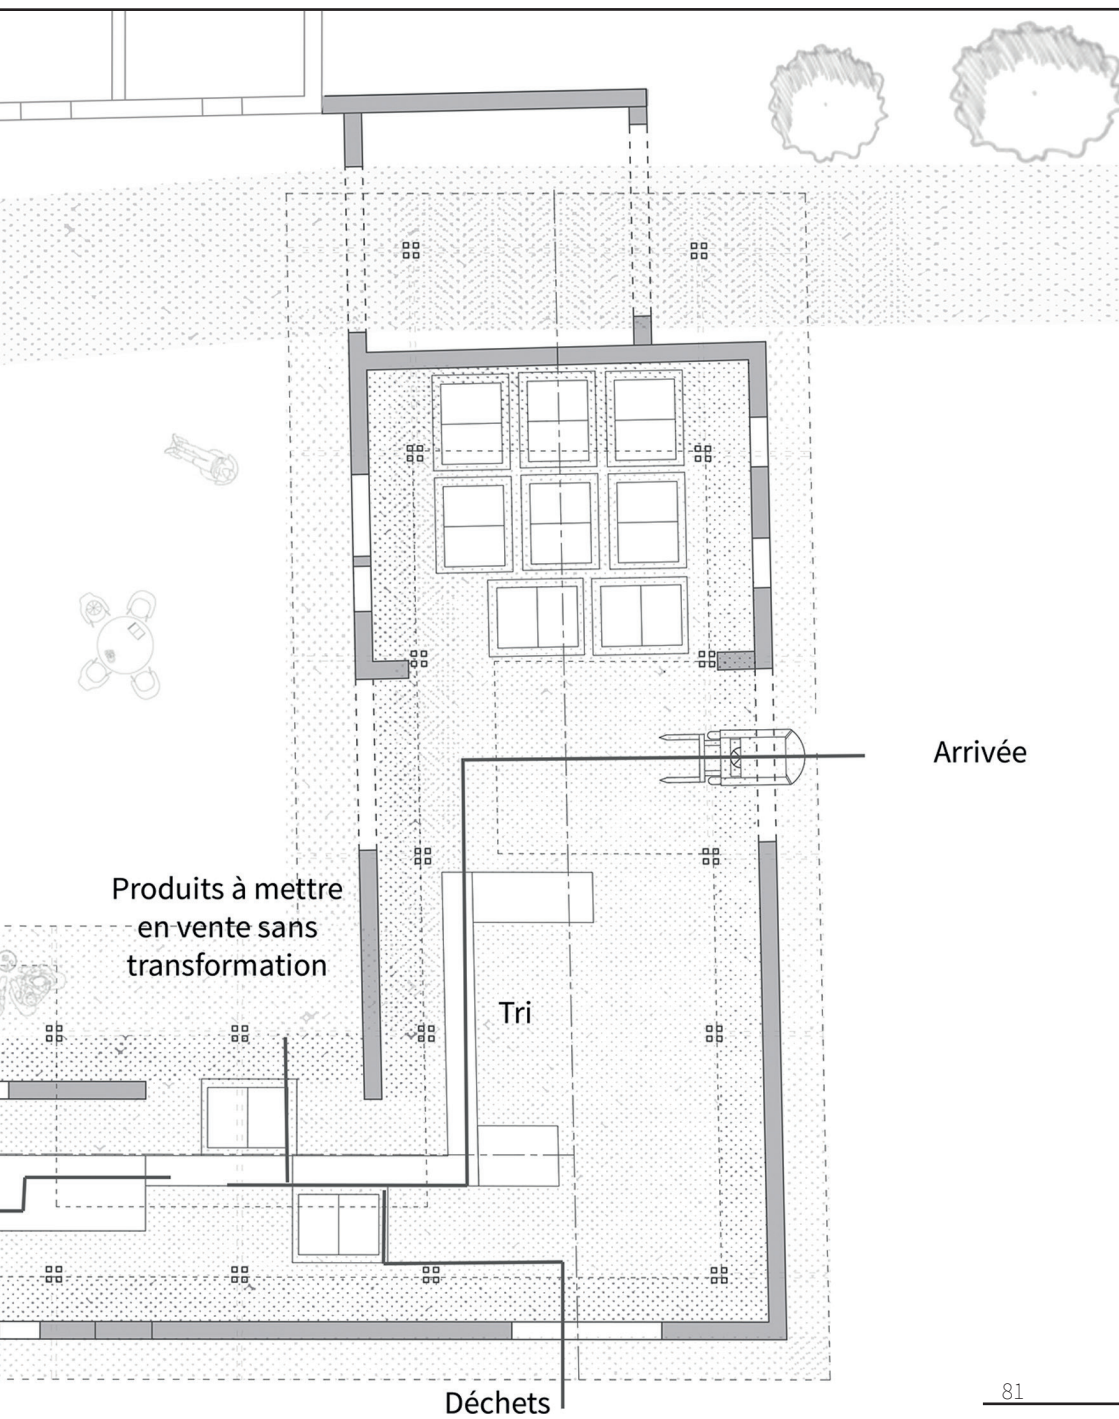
Plan rez-de-chaussée, échelle 1:150
